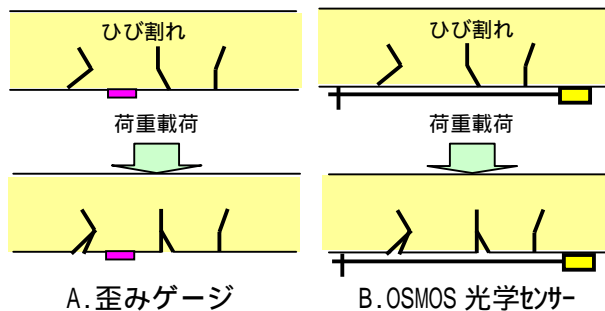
ひび割れ構造物へのセンサー取付概念
